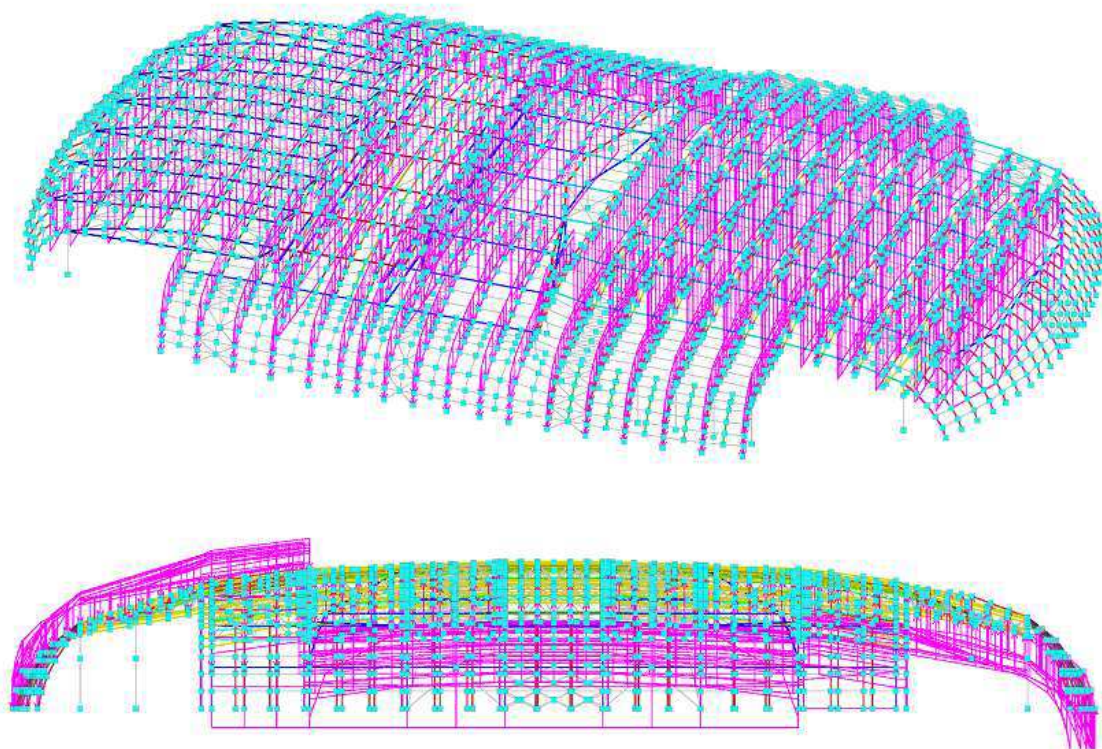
Схема загрузки ветровой нагрузкой вдоль покрытия (по оси Y) (загрузка 8)
